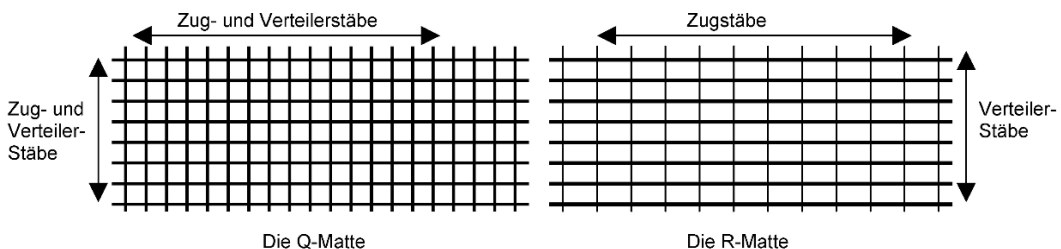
Das Prinzip des Lagermattenaufbaus
